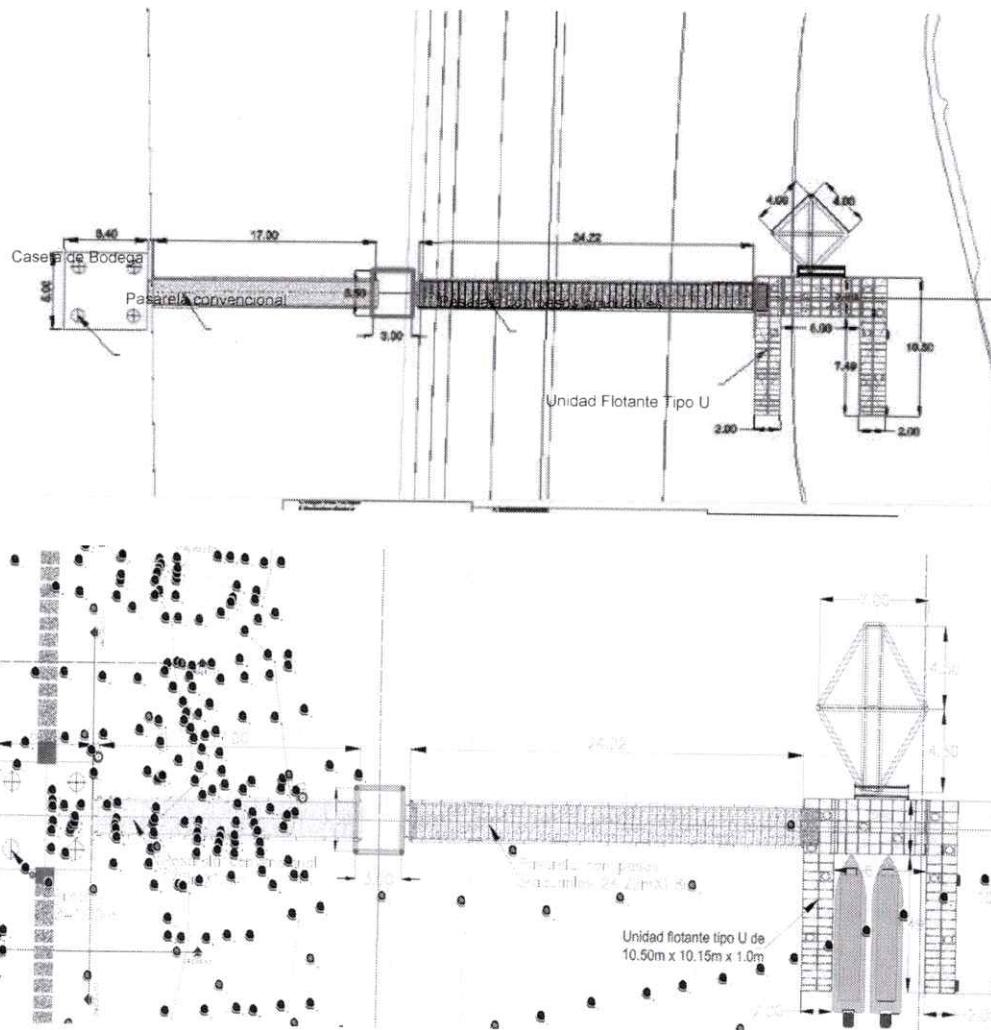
Vista en Planta del muelle proyectado para Monte Bravo.
